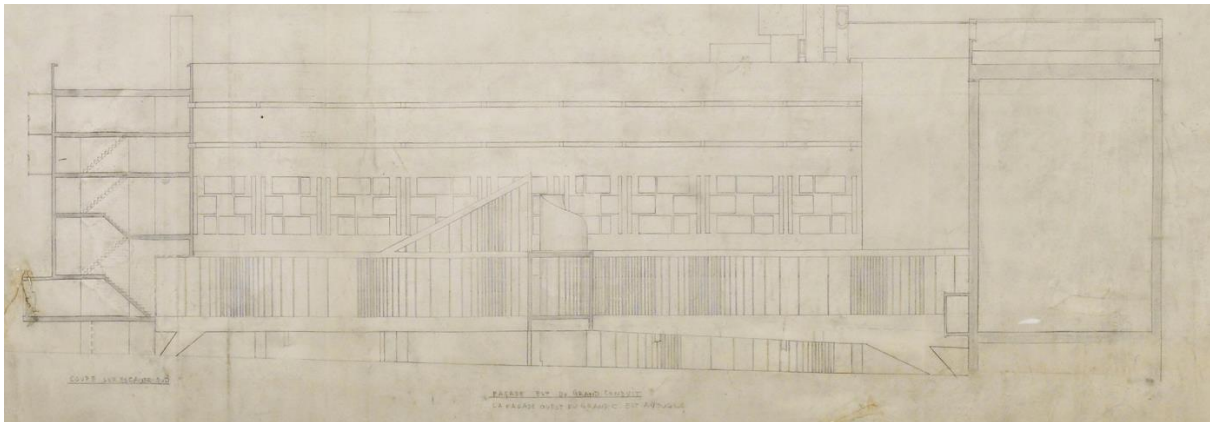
Détail de la fig. 63 avec coupe sur le petit conduit et continuité du pan de verre ondulatoire du grand conduit. (©FLC-Prolitteris)
